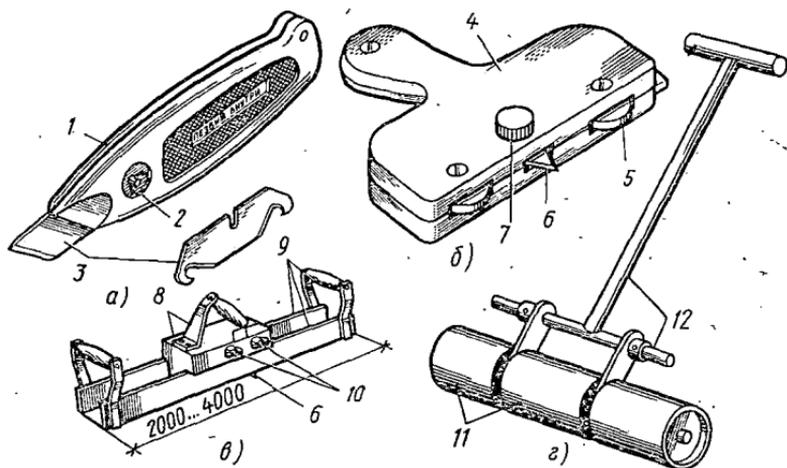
Инструменты для устройства полов из линолеума: *а* — нож со сменными лезвиями; *б* — специальный нож, *в* — приспособление для прирезки кромок полотнищ, *г* — ручной каток; 1, 4 — корпуса, 2 — зажимной винт, 3 — сменные лезвия, 5 — подшипник, 6 — нож, 7 — стопорный винт, 8 — корпус с ручкой, 9 — направляющая с ручками, 10 — прижимные винты, 11 — чугунные валики, 12 — рама с ручкой
